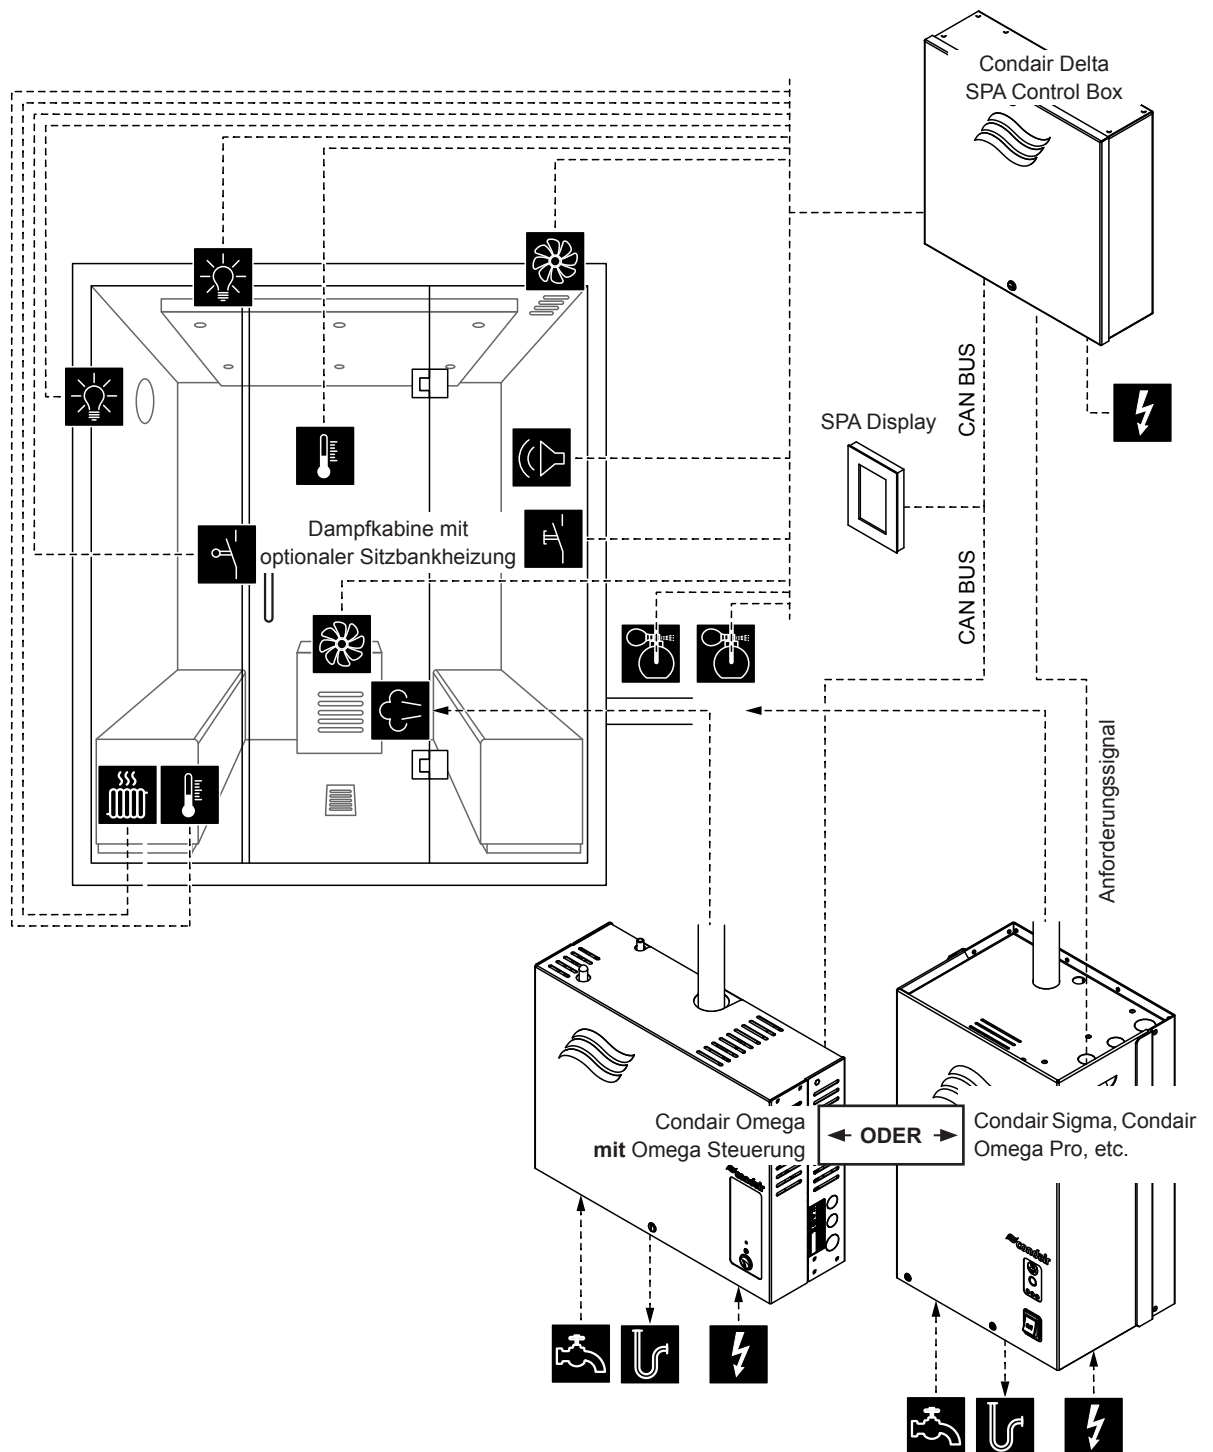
Condair Delta SPA Control Box mit Ausrüstung für Dampfbadanwendung mit optionaler Sitzbankheizung
